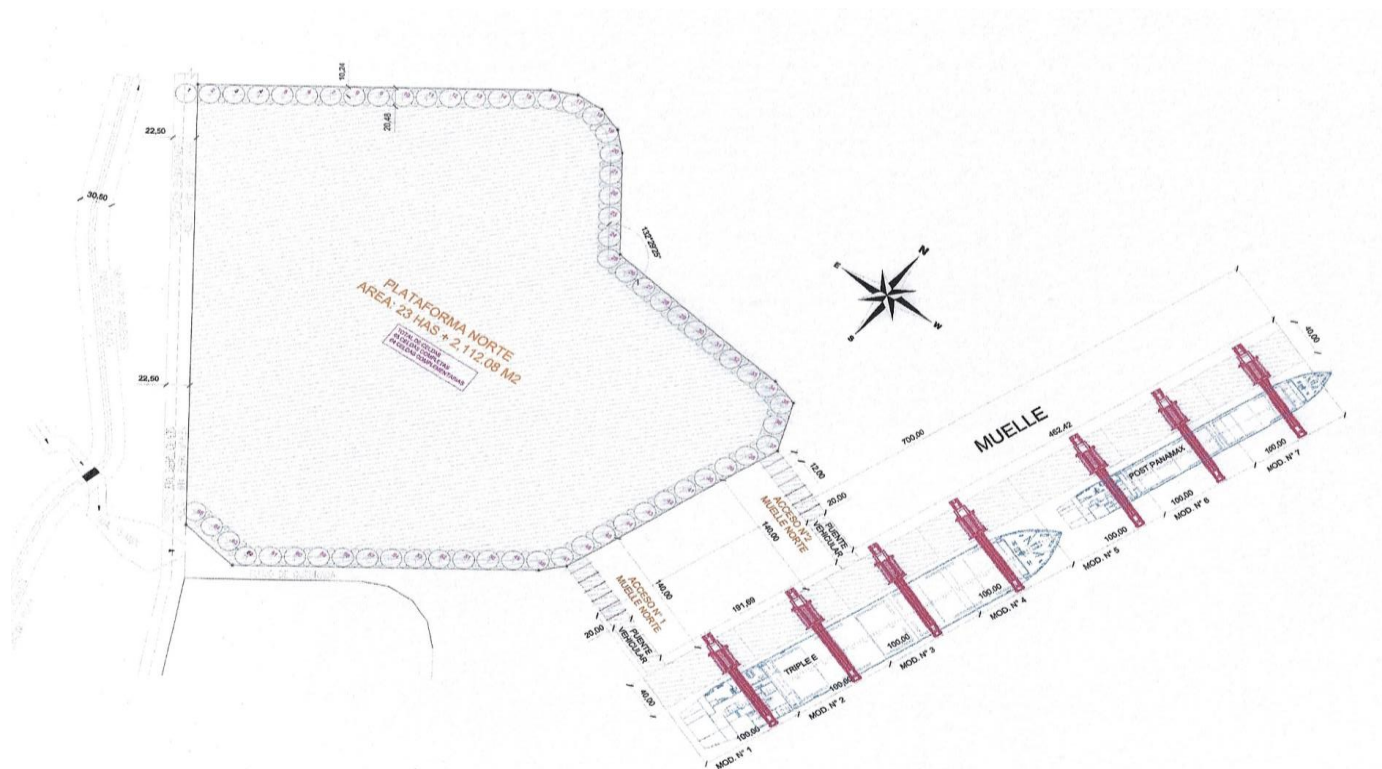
Croquis de infraestructuras futuras MARINE DEEP PORT, S.A.
